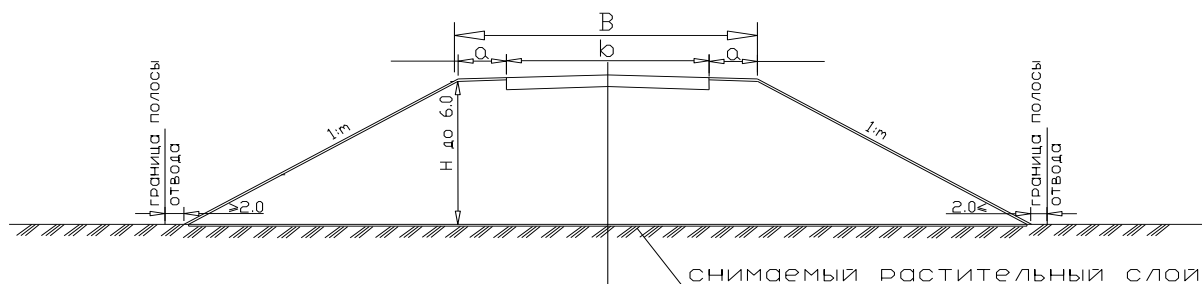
Поперечный профиль насыпи с высотой откоса до 6 м
